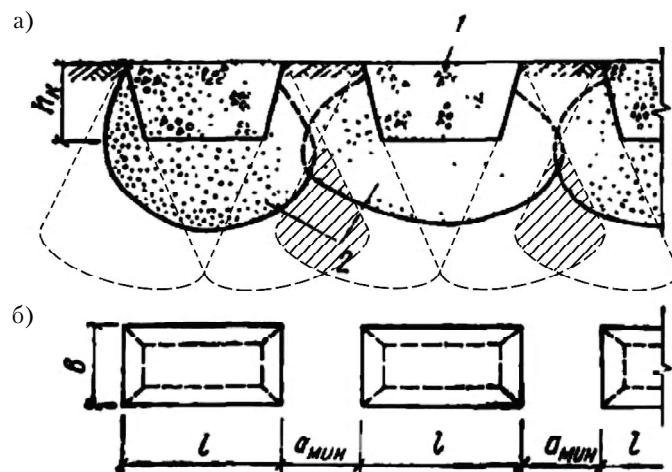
Ленточные прерывистые фундаменты в вытрамбованных котлованах: а) разрез по ленточным прерывистым фундаментам; б) вид в плане; 1 – ленточный прерывистый фундамент; 2 – уплотненная зона.
